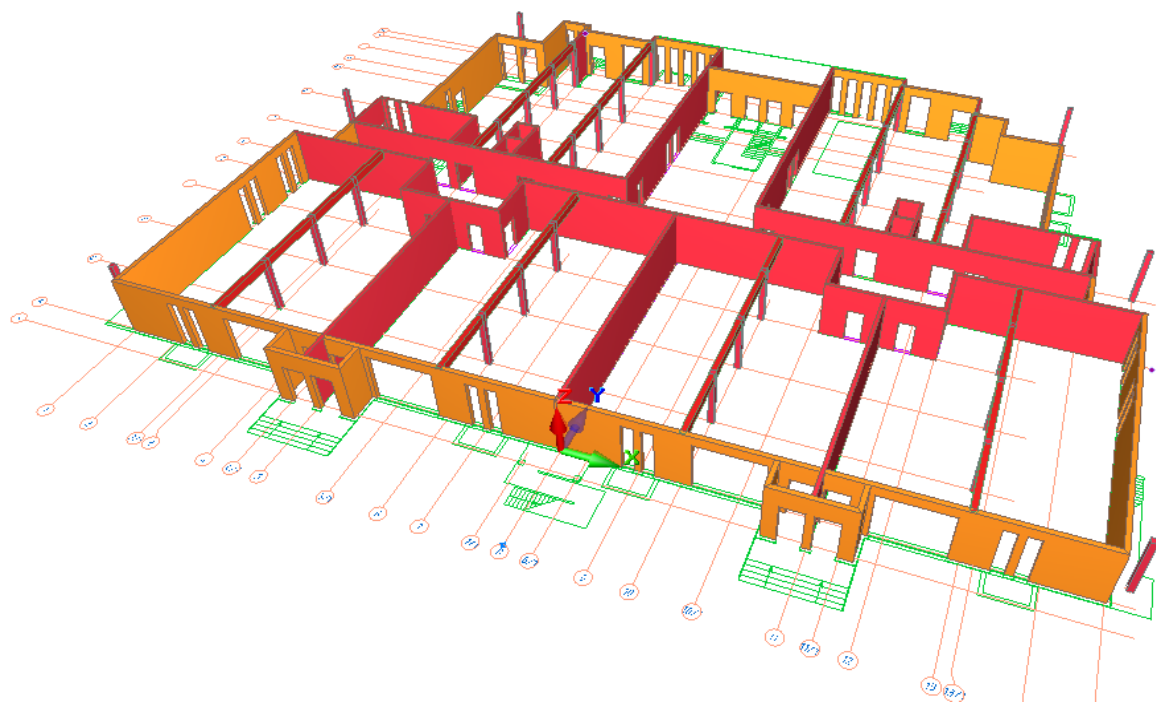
Построение модели железобетонных и кирпичных стен
